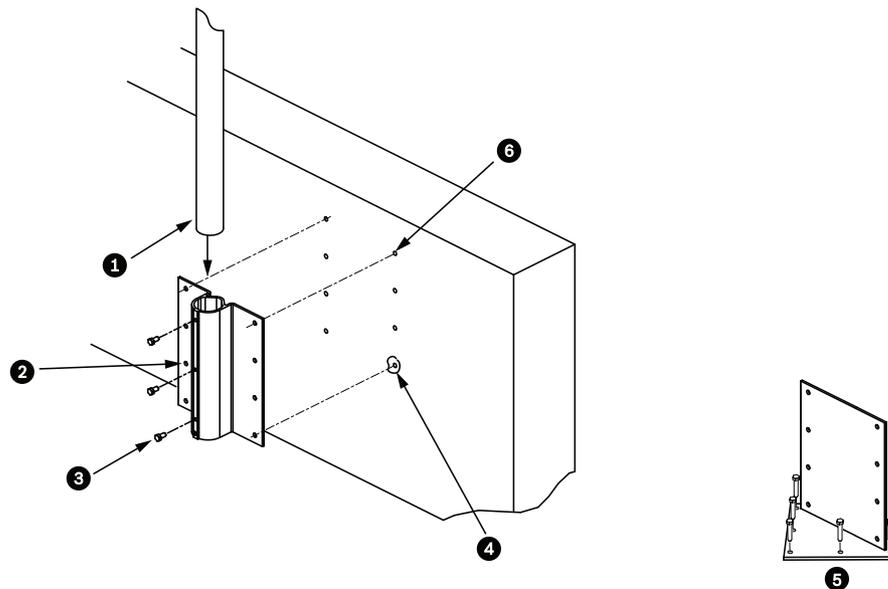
Soporte de sujeción en pared y placa de montaje en azotea
